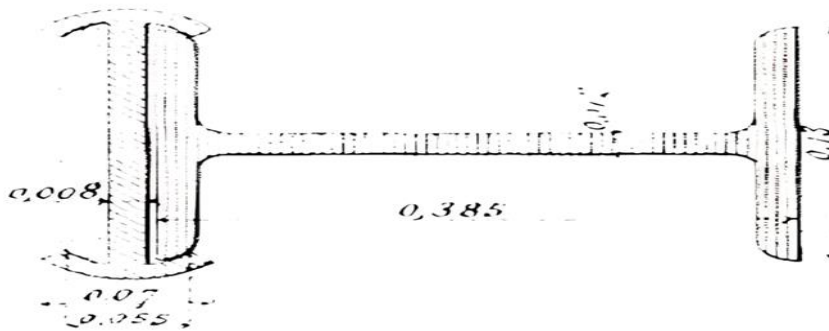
Palplanches constituées de profilés I (d'après Caudreier, 1913).
